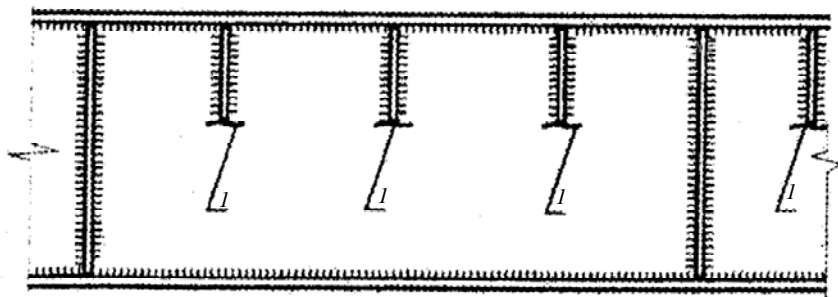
Характерные трещины в сварной подкрановой балке:
